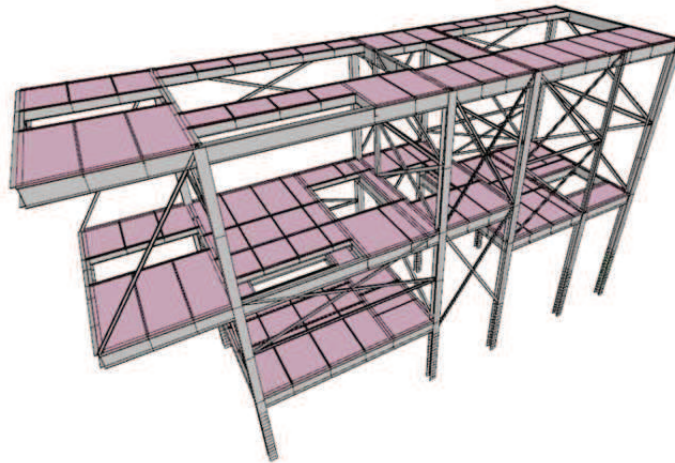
A Representació de les superfícies que conformen les plataformes
